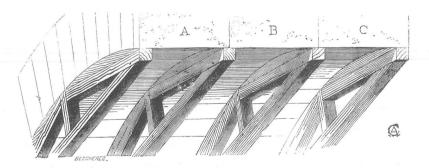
Construcción de bóvedas de cantería sin forro sobre las cimbras (Pont du Gard)
